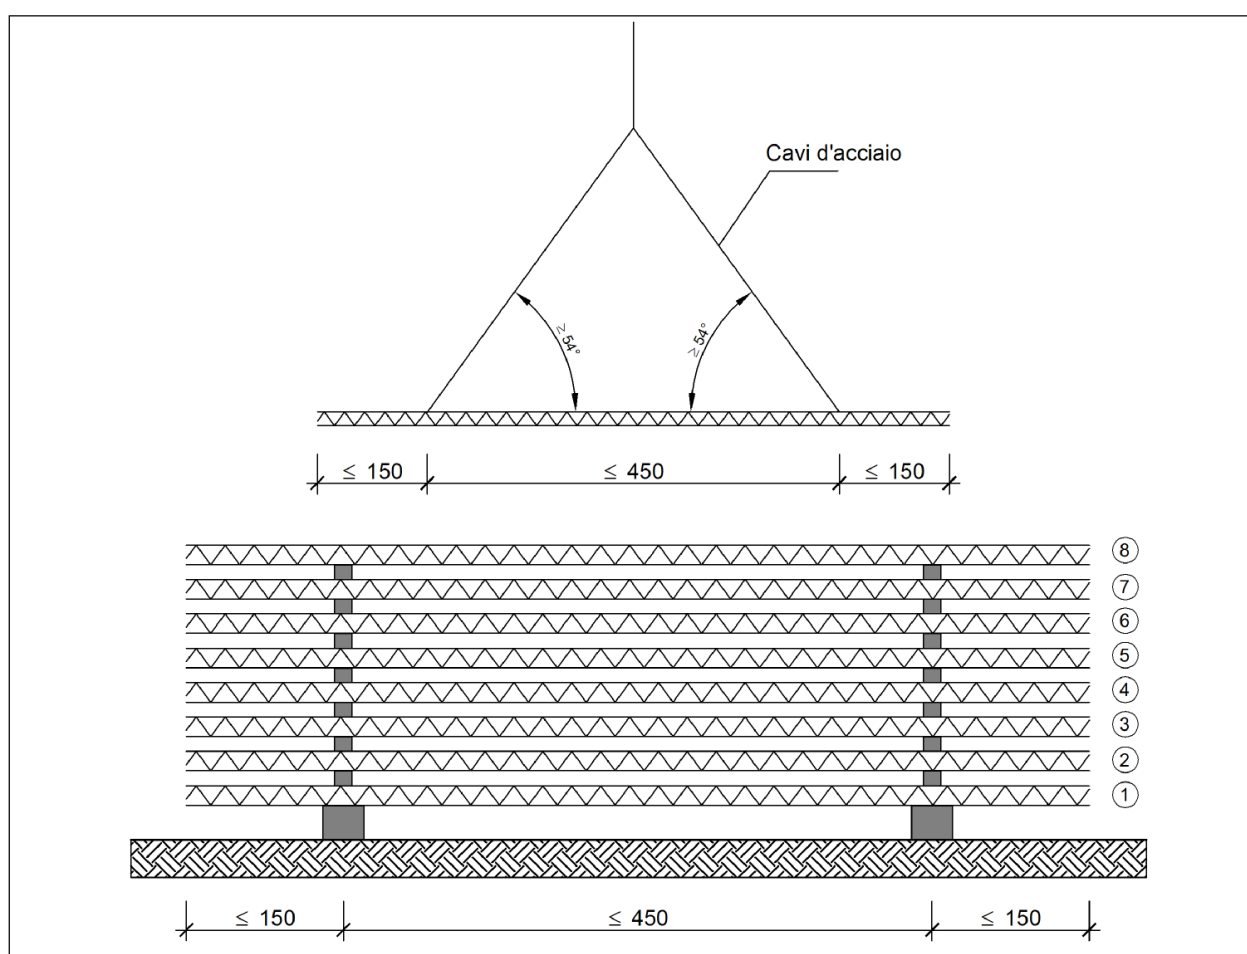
Esempio di stoccaggio di travetti tralicciati
